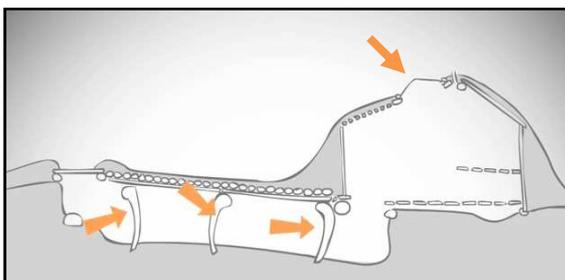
(1) Sección vivienda excavada. (2) Vértebras de ballena
